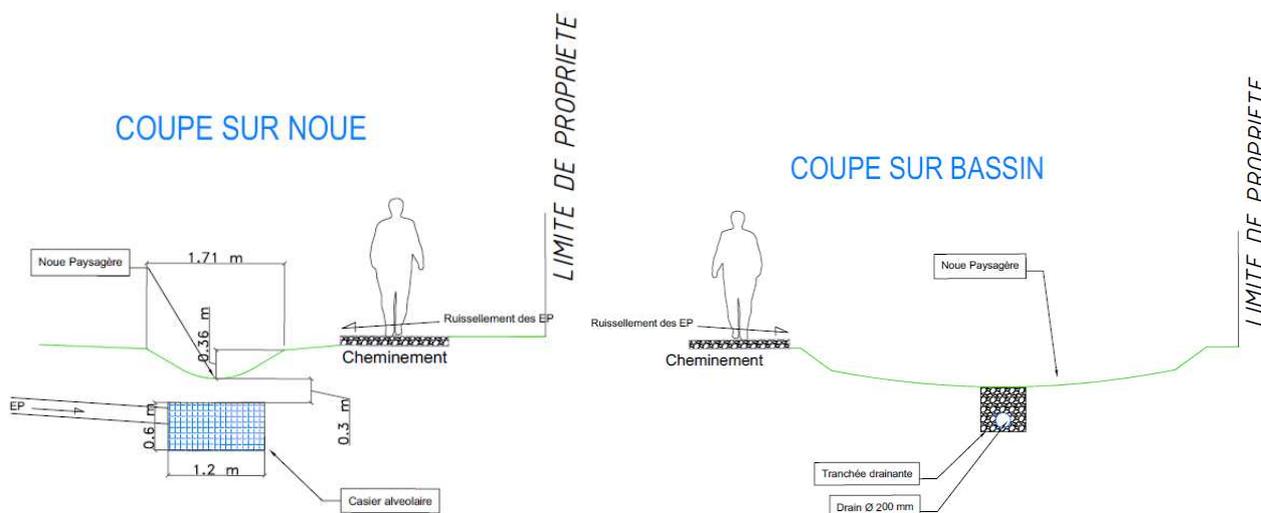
Système d'assainissement des eaux pluviales retenu (source : PITCH)
